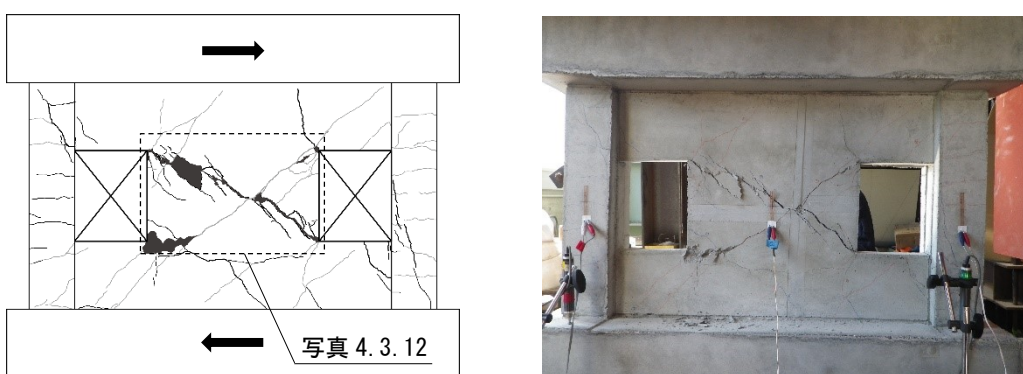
ひび割れ状況図 (⇒:実験終了時の加力方向) (続き)
